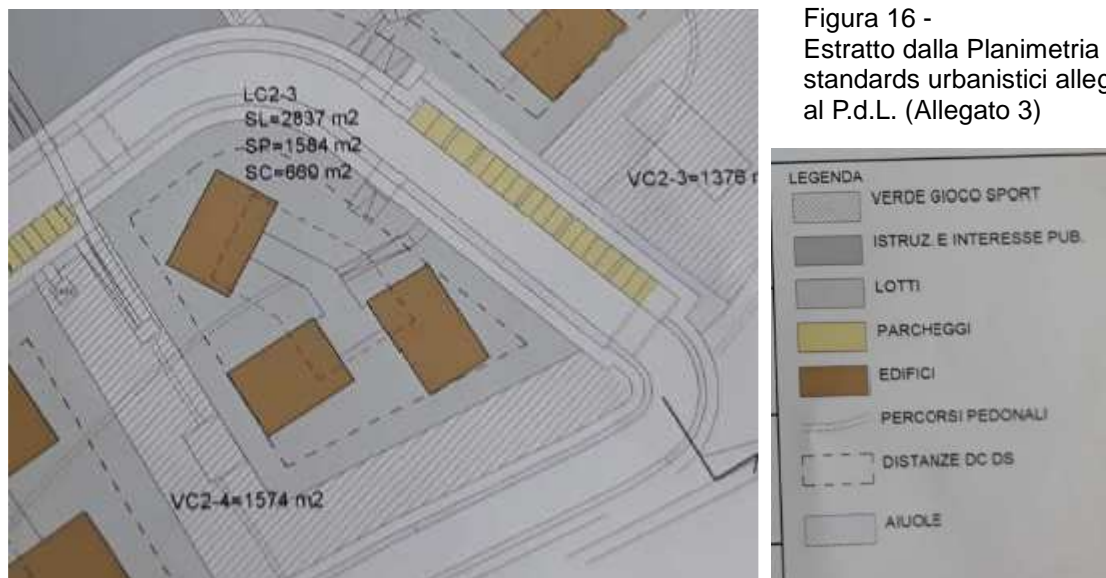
Estratto dalla Planimetria con standards urbanistici allegato al P.d.L. (Allegato 3)
